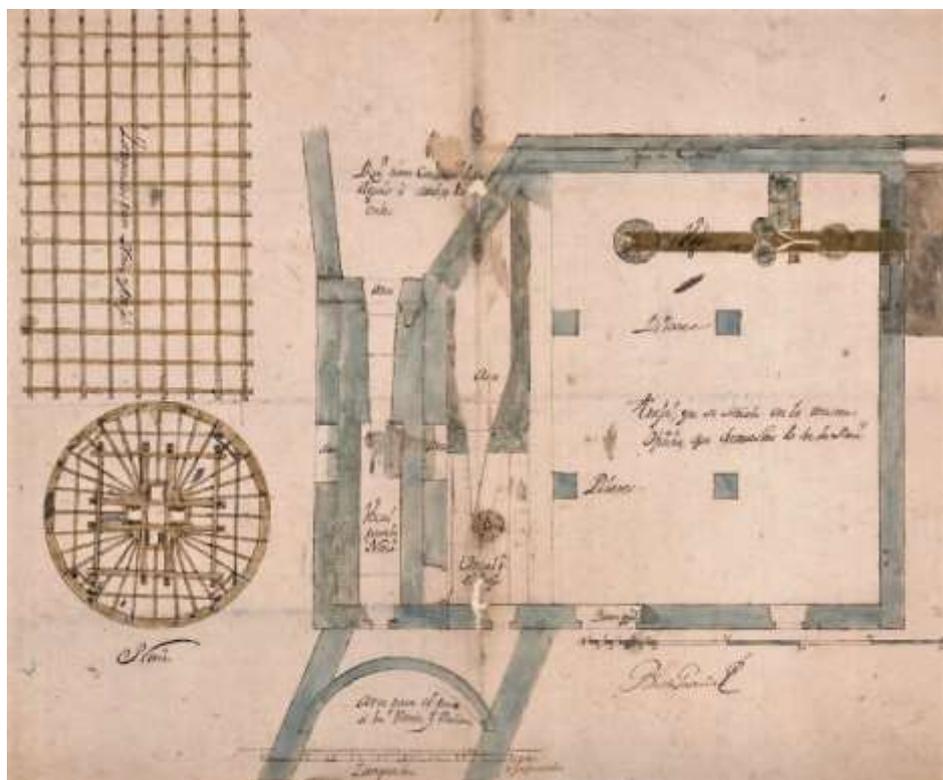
Plano de planta del trujal y noria de Lodosa. Fondo del Consejo Real de Navarra.
